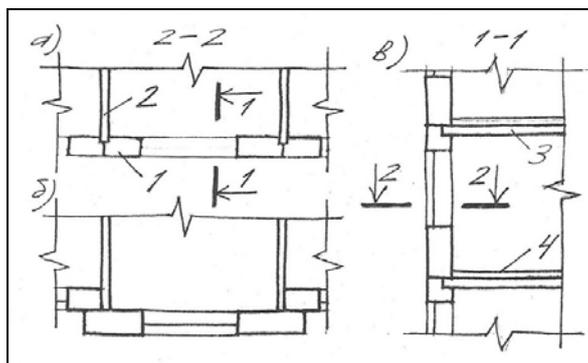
Схемы фрагментов разрезов крупнопанельных зданий по наружным стенам; а, б – разрезы горизонтальной плоскостью, в – разрез вертикальной плоскостью; а – сопряжение наружных стеновых панелей встык, б – сопряжение наружных стеновых панелей внахлестку; 1 – наружная стеновая панель, 2 – внутренняя стеновая панель, 3 – плита перекрытия, 4 – уровень поверхности пола
